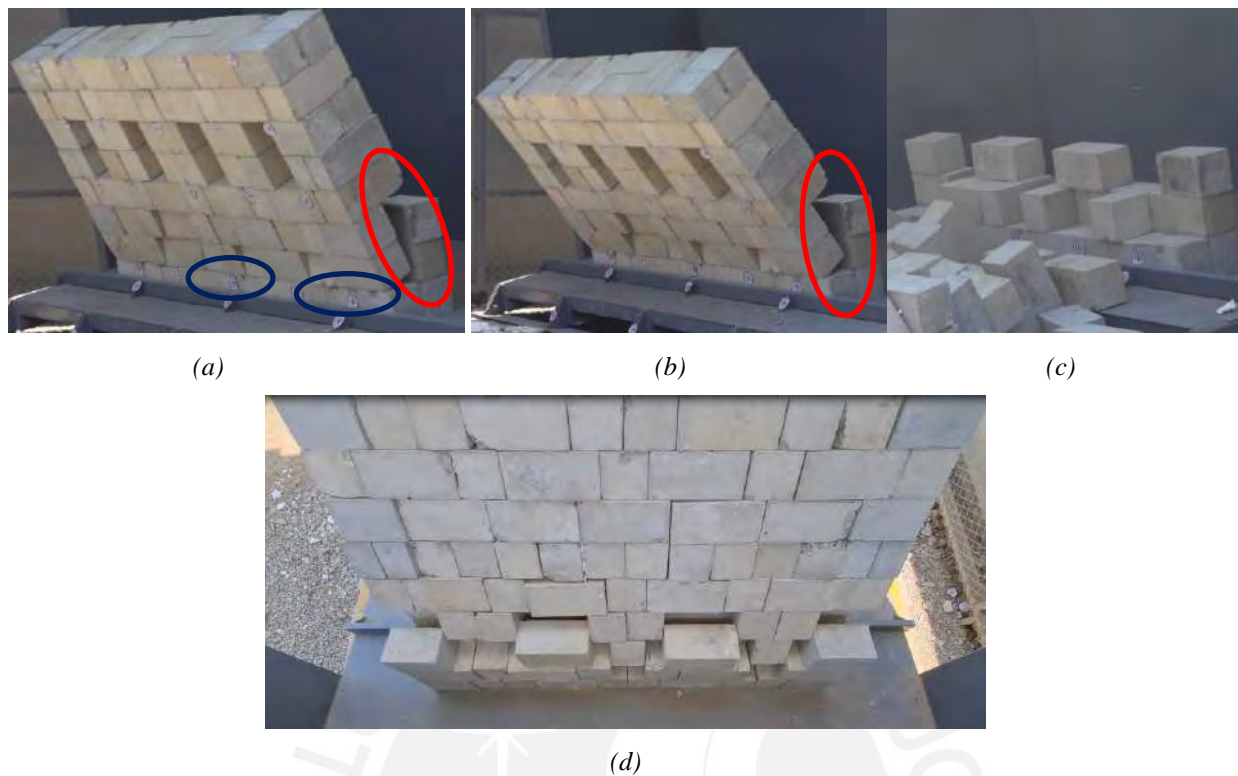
Vistas del muro 2 entre 10 y 11° de giro
